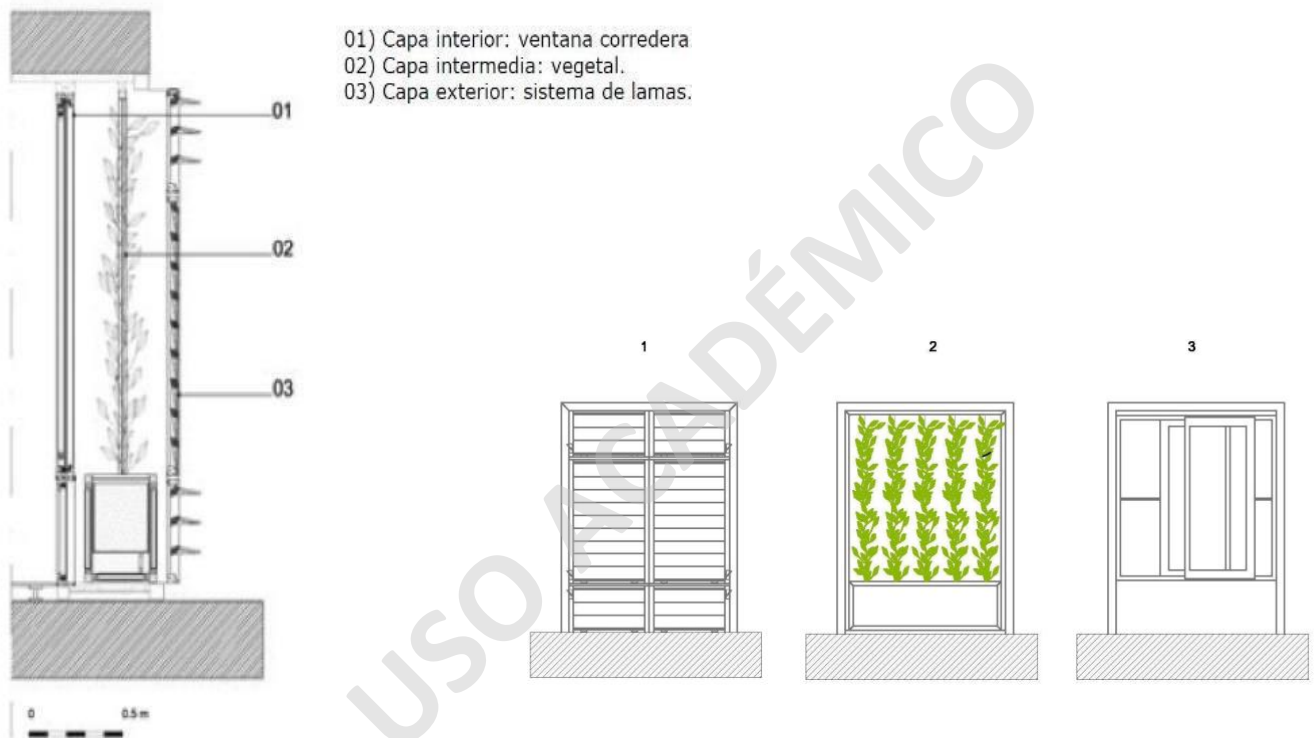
Detalle de la fachada vegetal tipo invernadero
